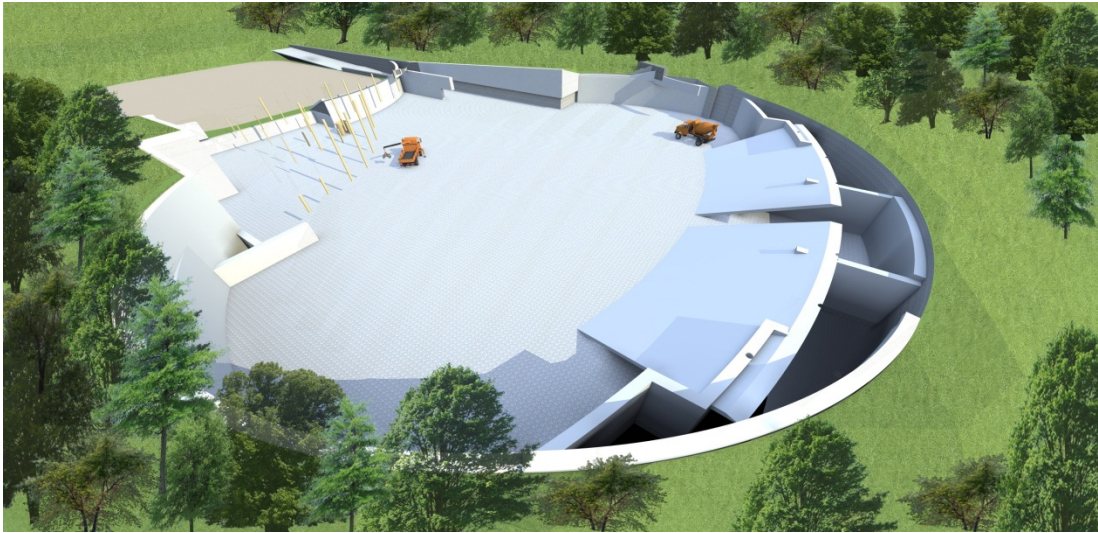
FASE DI CANTIERE – GETTO MURI DI CONTENIMENTO
